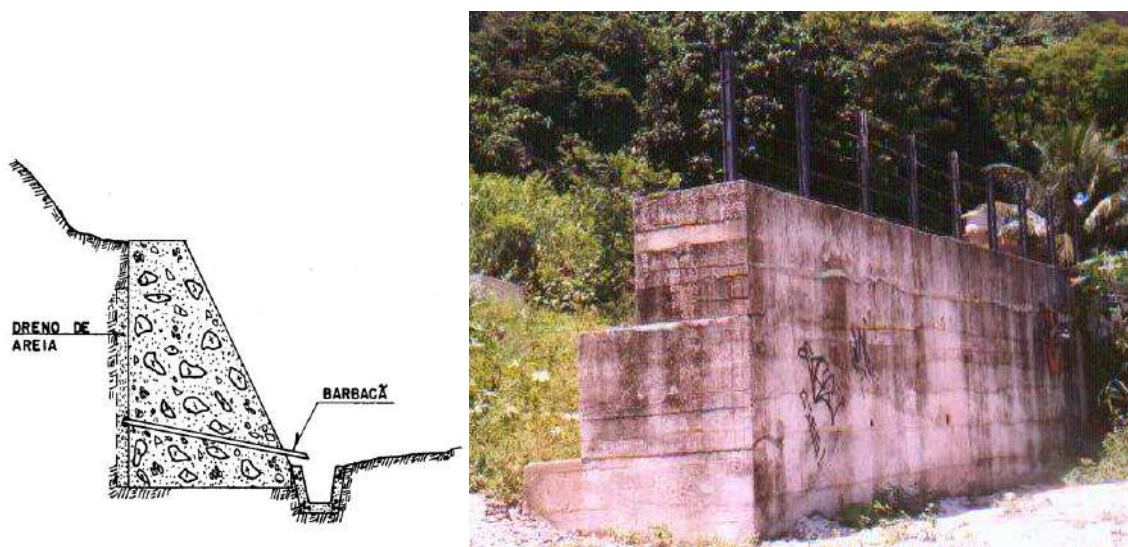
Muros de concreto ciclópico (ou concreto gravidade)
